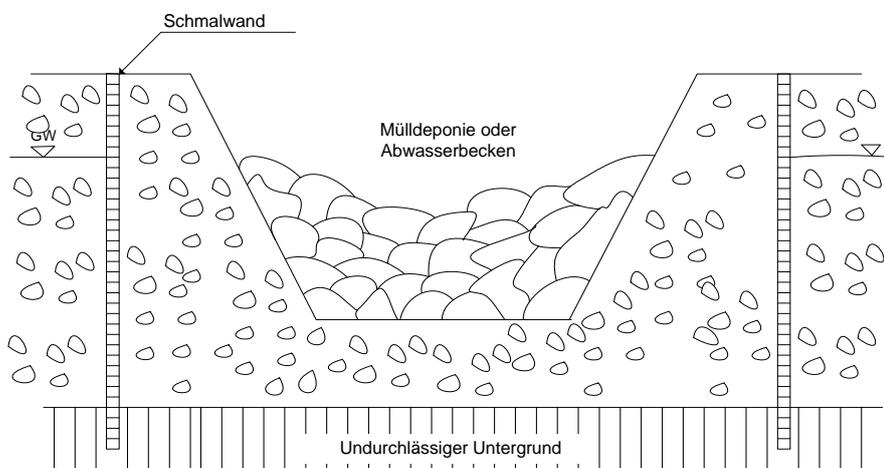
Schmalwand zur Sicherung des Grundwassers vor Verunreinigungen [1]
